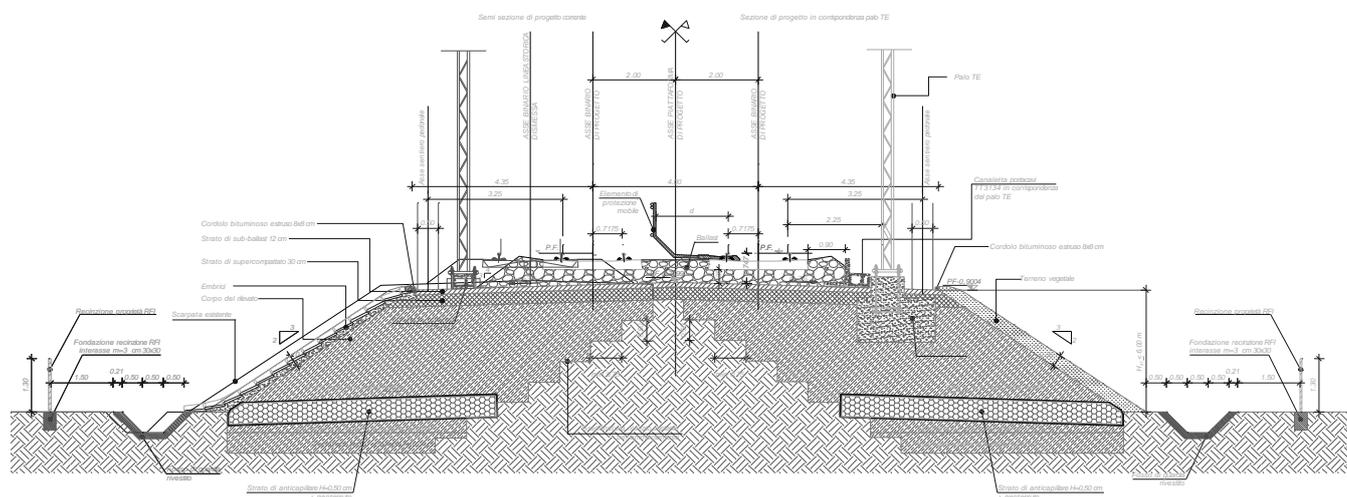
Stralcio planimetrico per sezione tipo ferroviaria in rilevato a doppio binario (piattaforma in retto) con $H_{ril} \leq 6,00$ m
